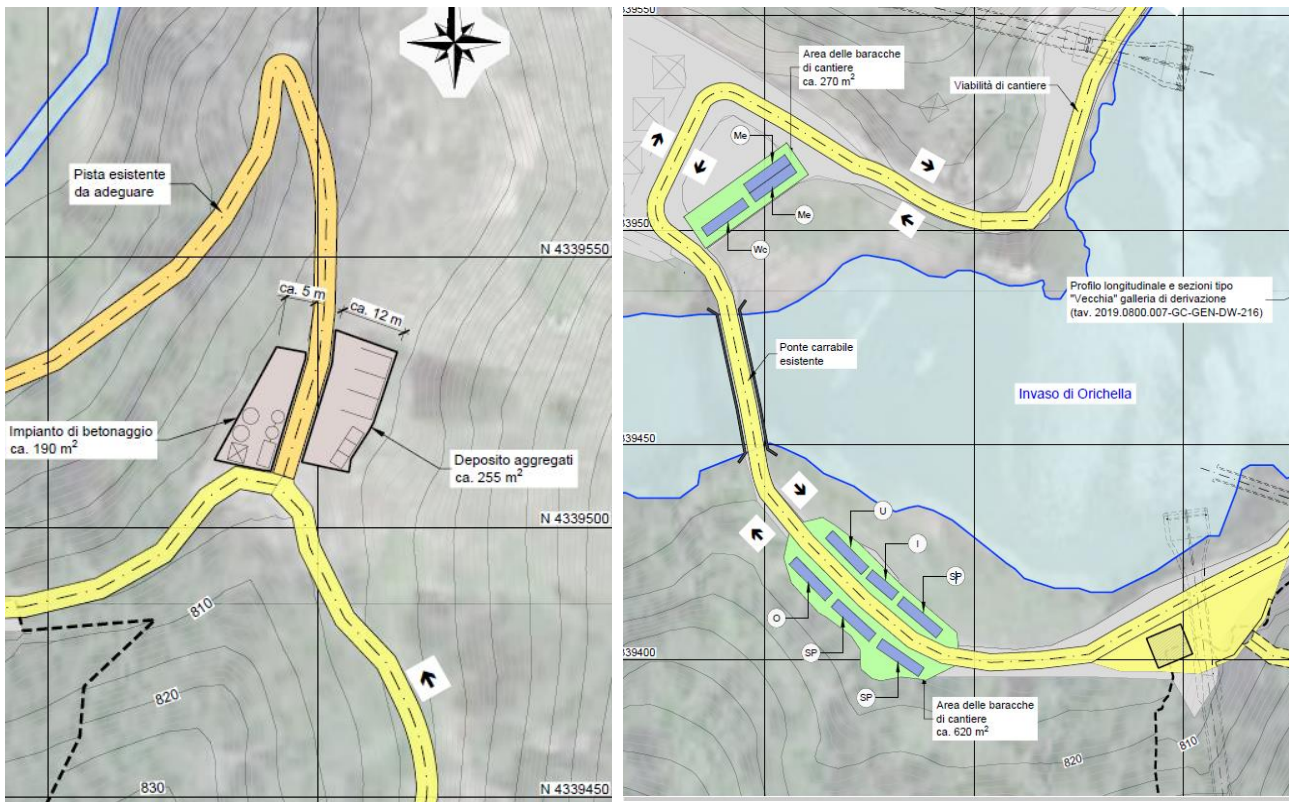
aree delle baracche e impianto di betonaggio a valle della diga di Orichella
